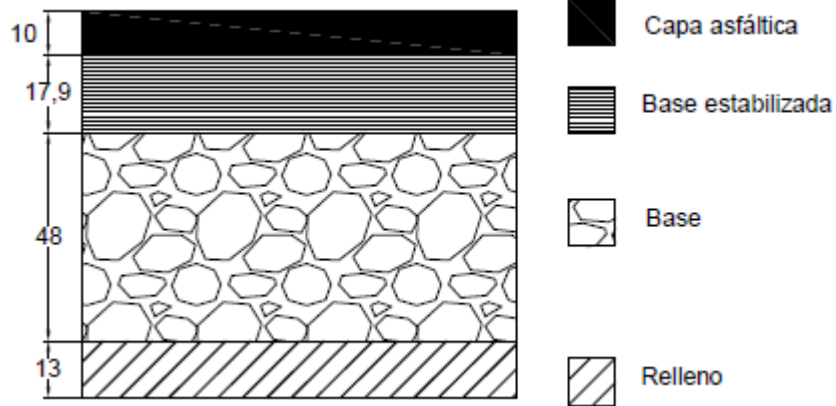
Espesores de pavimento realizado el 24 de junio de 2019 para el Tramo 13 (cotas en cm)
